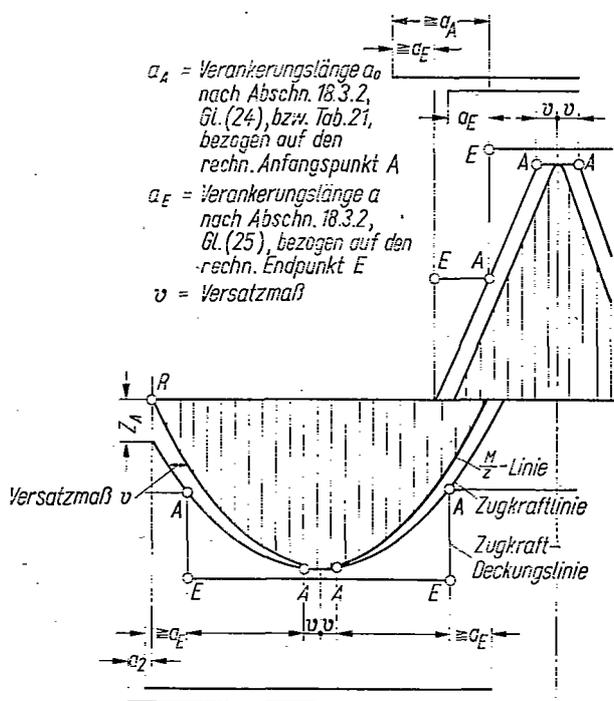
b. Beispiel für eine gestaffelte Bewehrung für Platten mit Bewehrungsstäben $d_e \leq 14$ mm bei reiner Biegung
